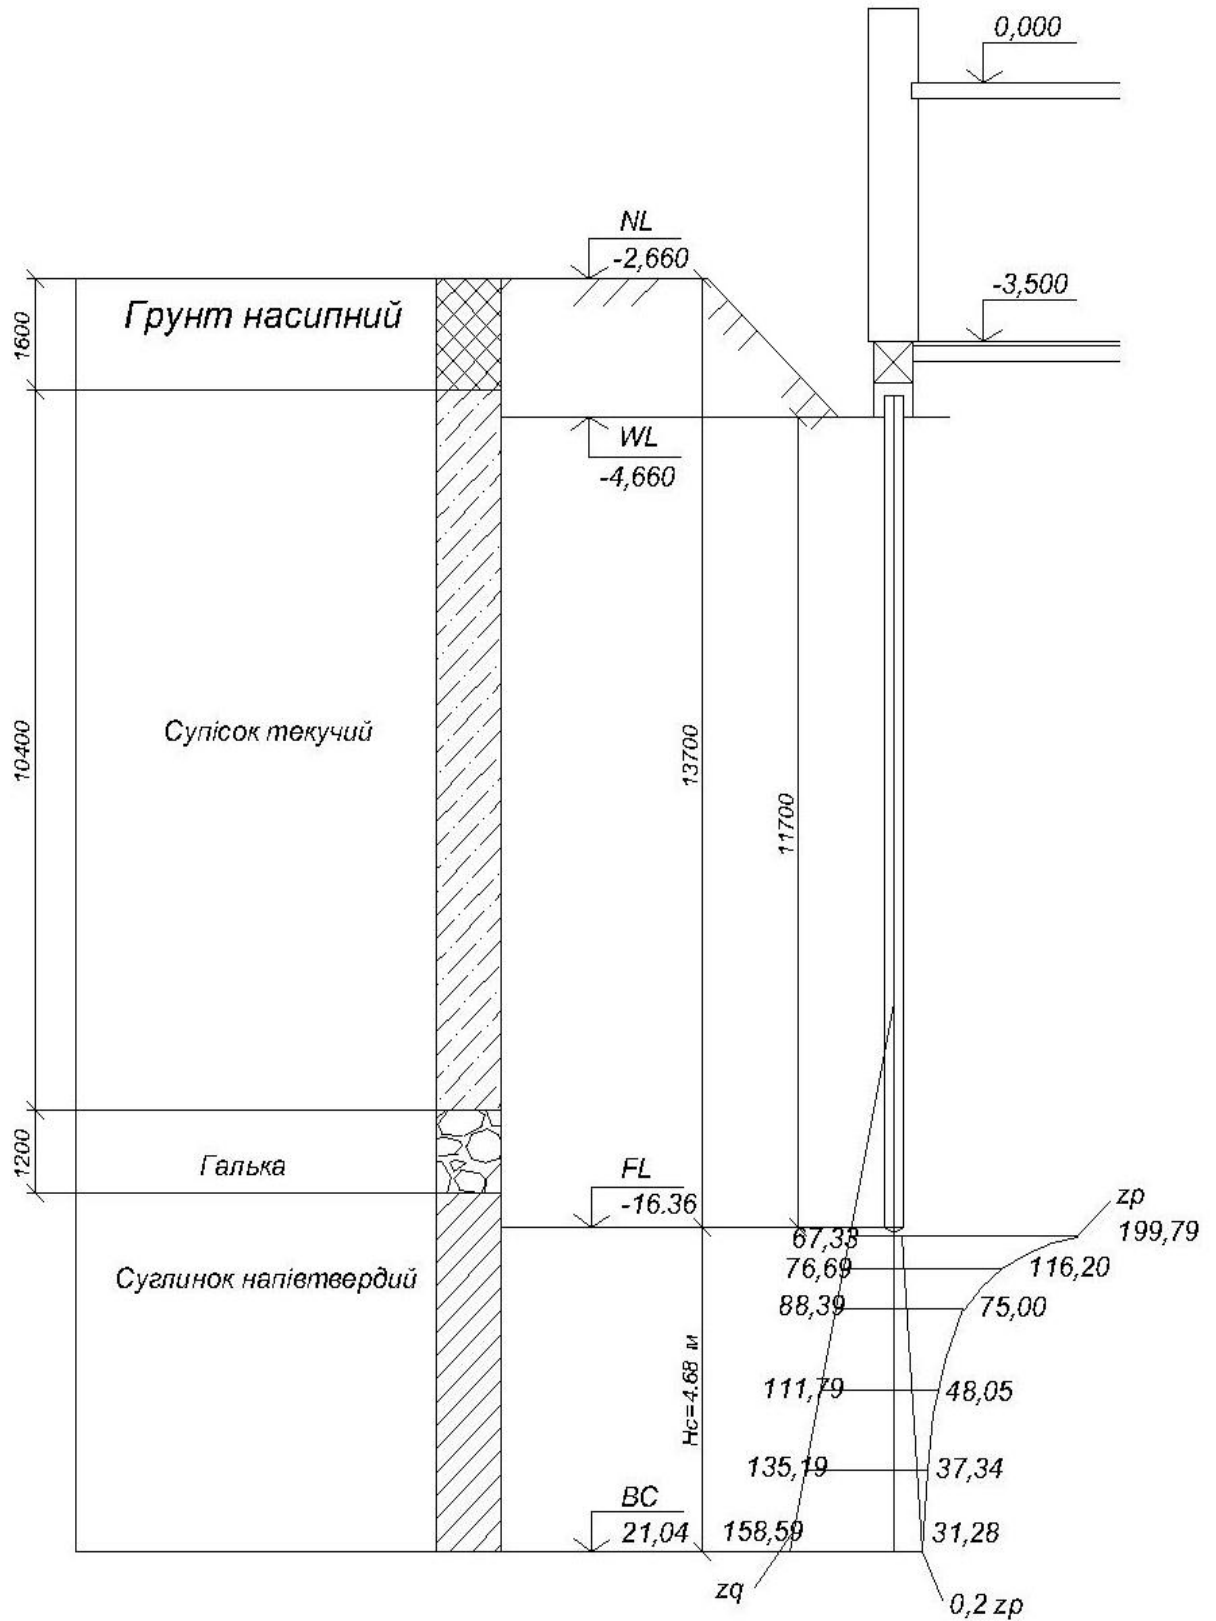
Схема до розрахунку просідання стрічкового пальового фундаменту по осі А на ділянці 14-20
